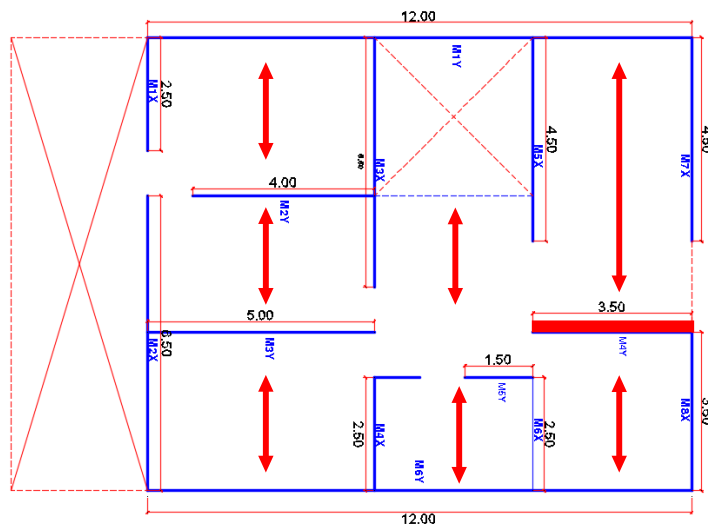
Direccionamiento de las losas aligeradas de 25 cm y muro más cargado axialmente (M4Y)
